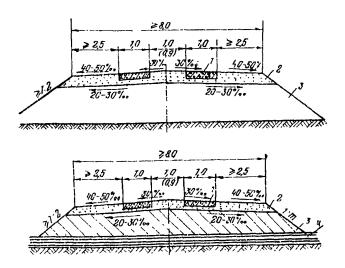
Поперечные профили однополосных дорог со сборным колейным покрытием из железобетонных плит при строительстве трубопроводов диаметром до 1020 ым:
